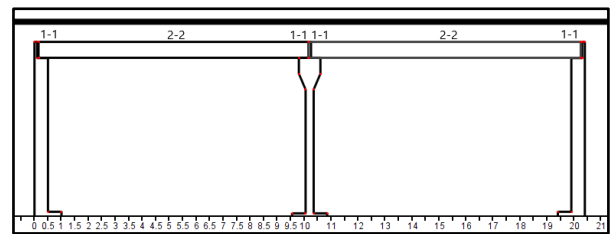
Secciones críticas en los elementos de la superestructura de puente.
